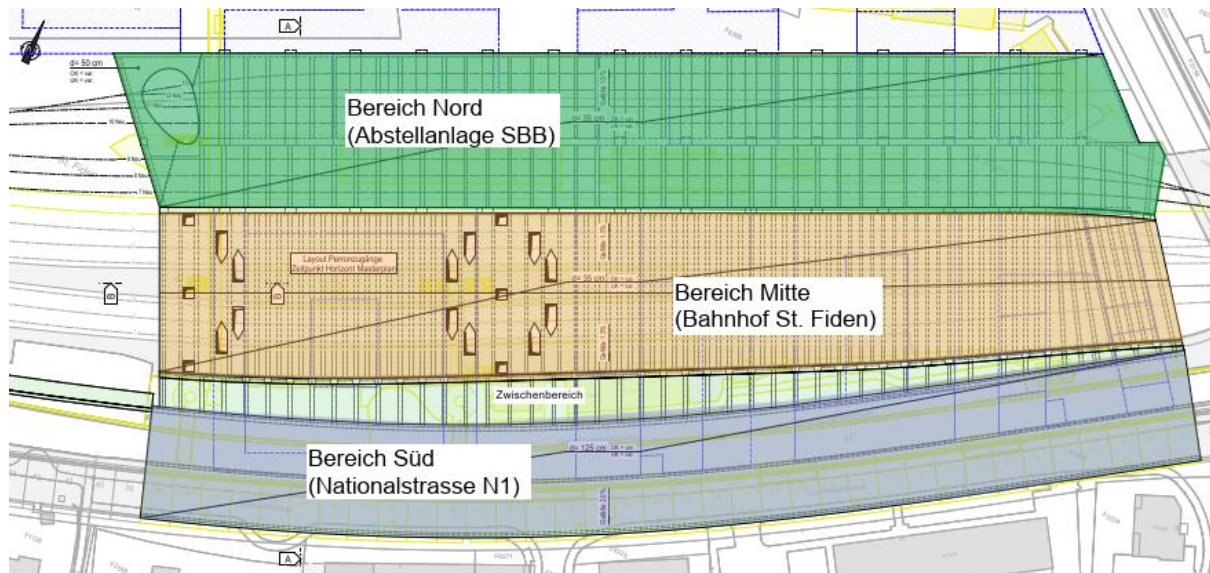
Grundriss Struktur Gesamtüberdeckung und Teilbereiche (Quelle: EBP)
